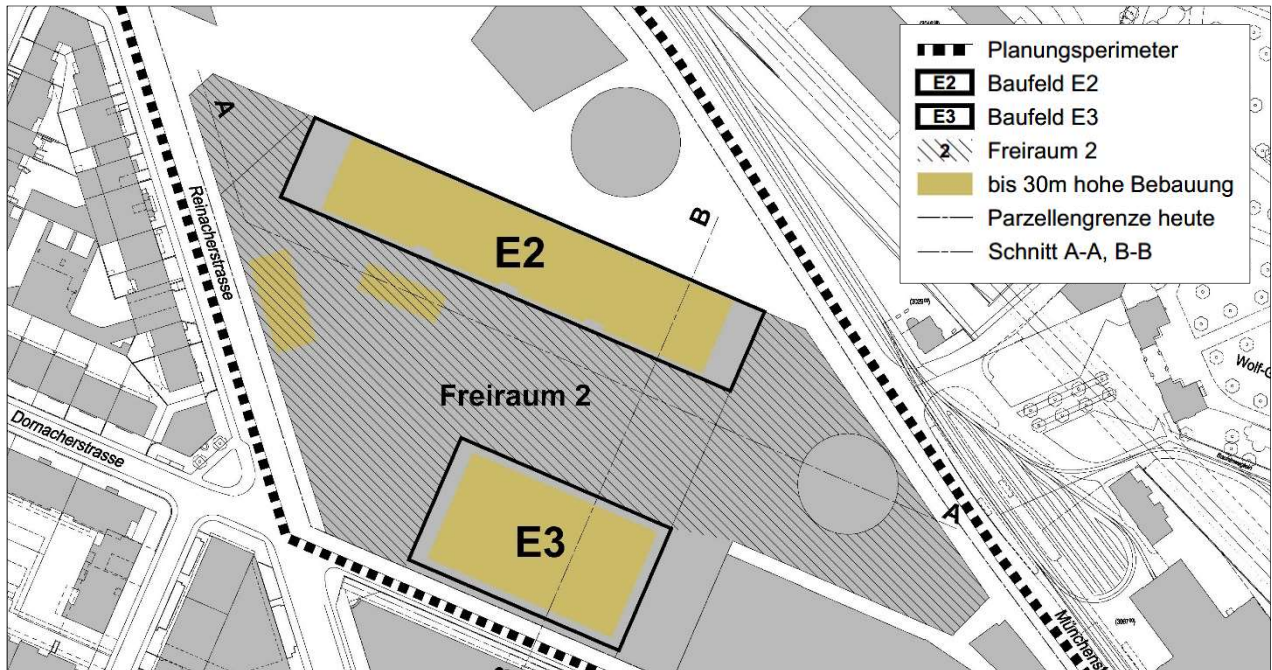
Bebauungsplan 3. OG bzw. Dach MParc, Situation. (Kein Massstab, Plan genordet)
